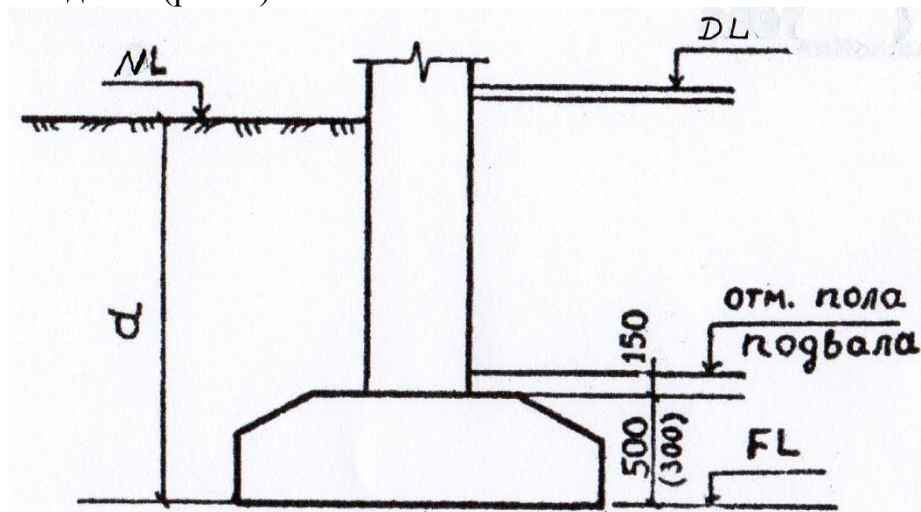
Схема для расчёта глубины заложения подошвы фундамента.
